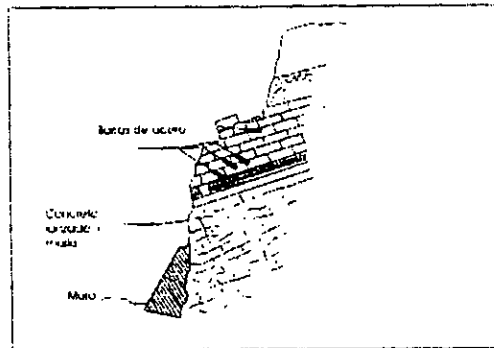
Fijación de bloques y concreto lanzado.
